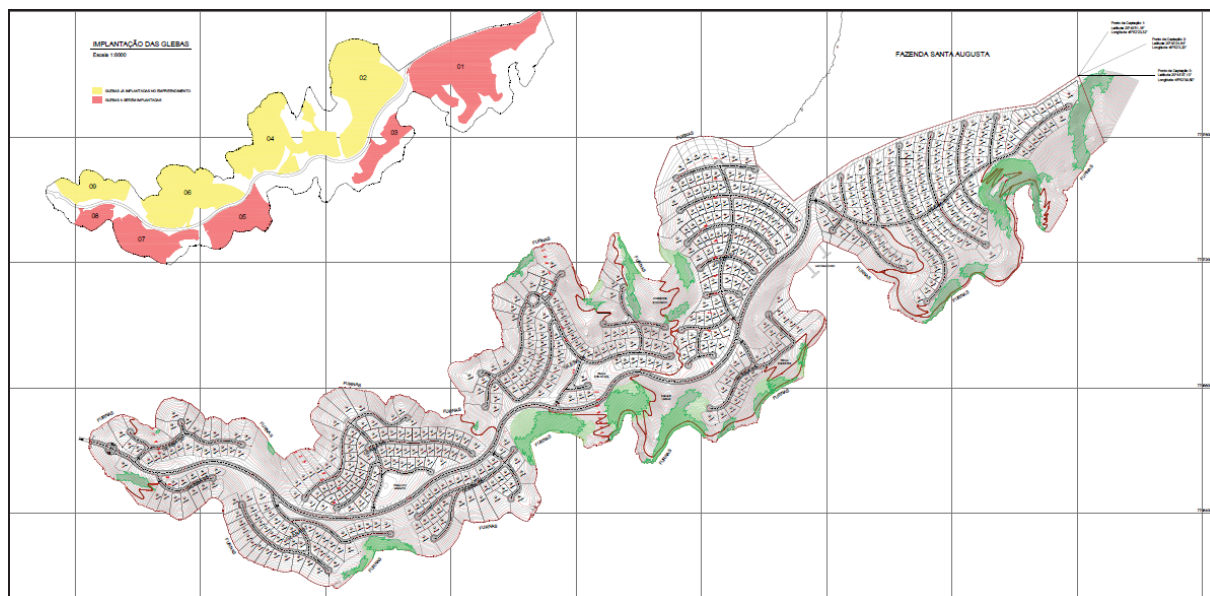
Planta platialtimétrica do loteamento com a disposição final dos lotes e infraestruturas concluídas. Fonte: *Processo SLA nº 5210/20201*.
